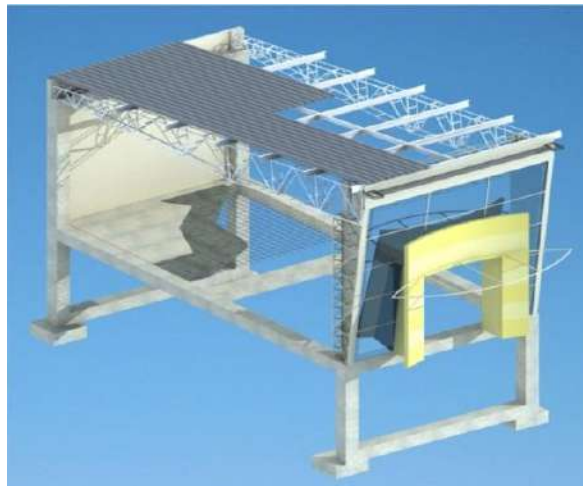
sistema constructivo pórticos metálicos celosía contemporáneo.
